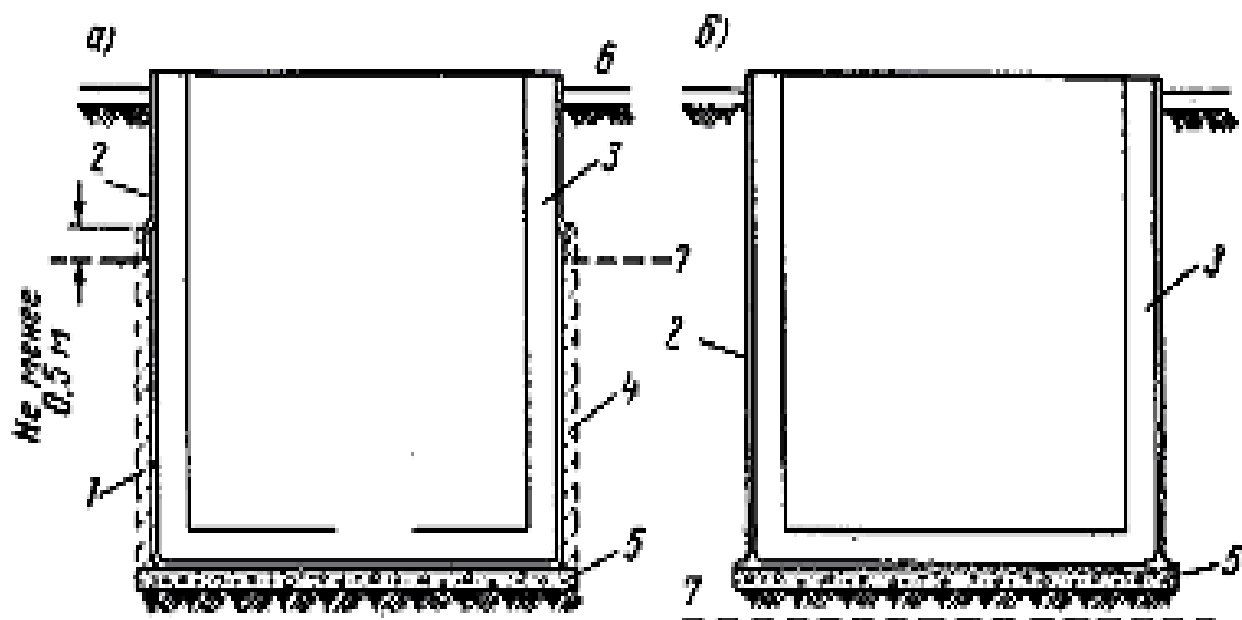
Схема гидроизоляции заглубленных сооружений:
